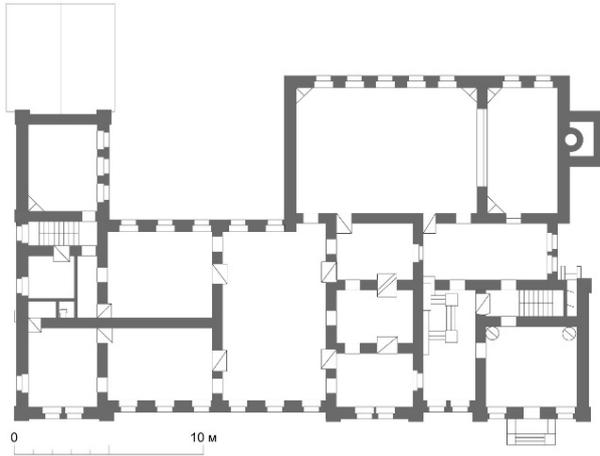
Дом генерал-губернатора, план первого этажа
